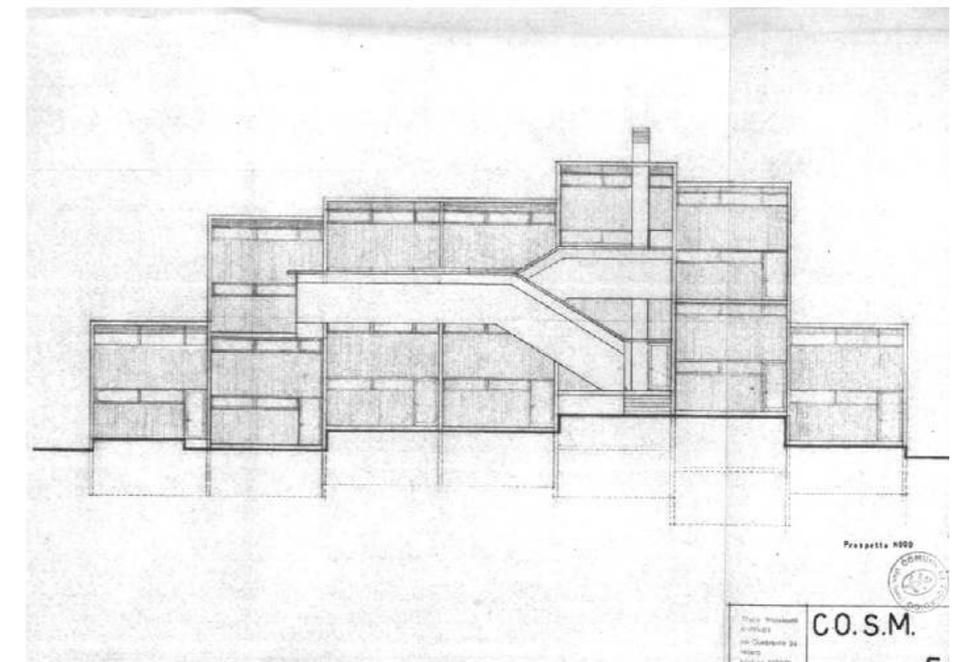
UHF-2 Plano definitivo de solución de fachada del conjunto del proyecto Unidad Habitacional La Fontanella.
